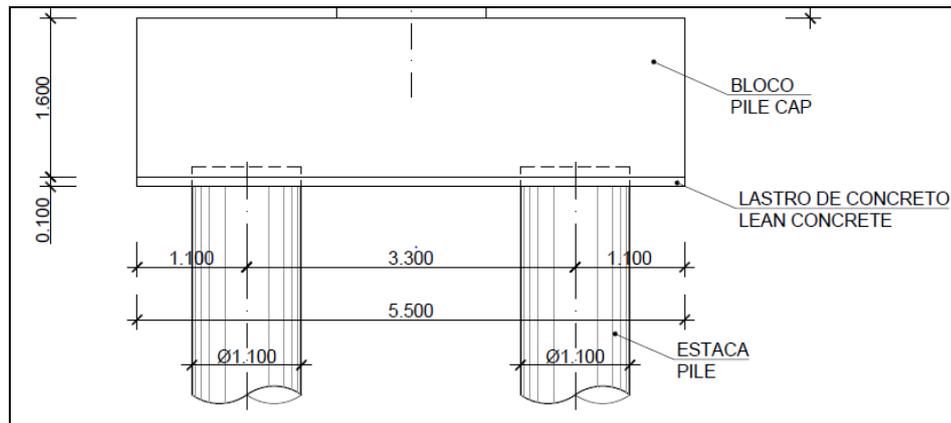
Detalhe do Bloco de Fundação.
